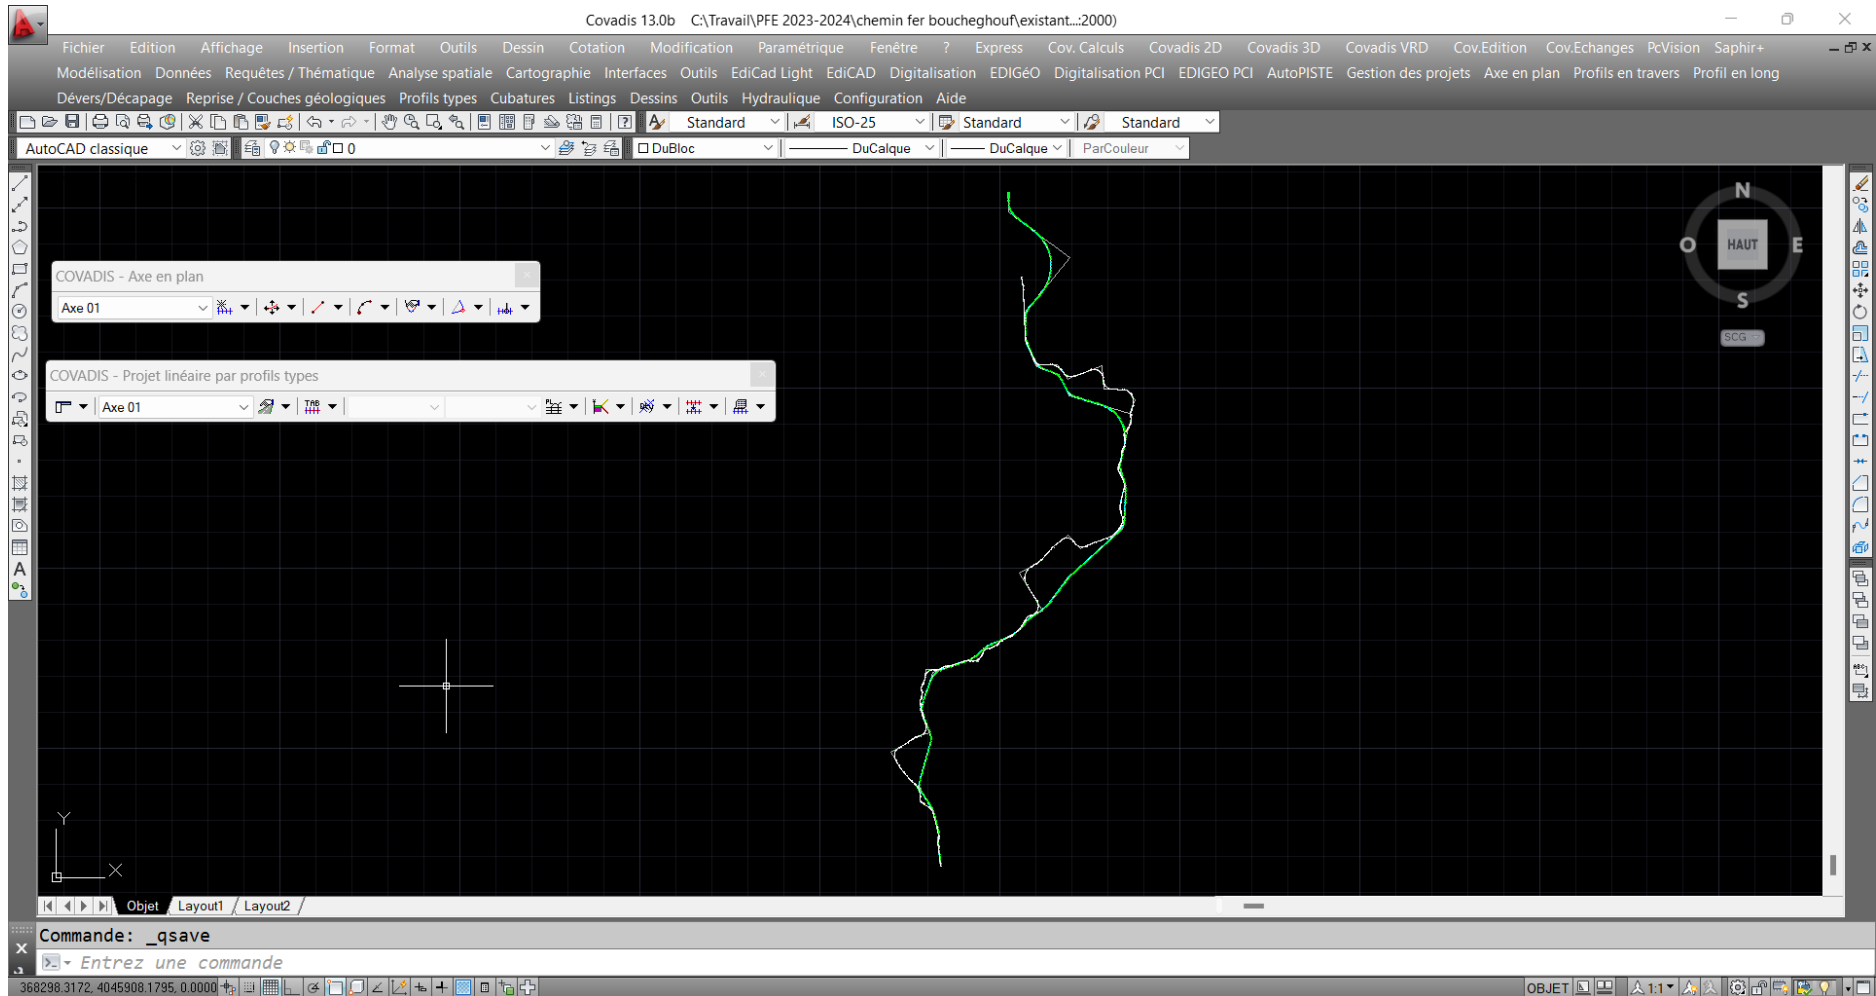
Tracé en plan rectifié de la ligne ferroviaire sur COVADIS (en vert)
